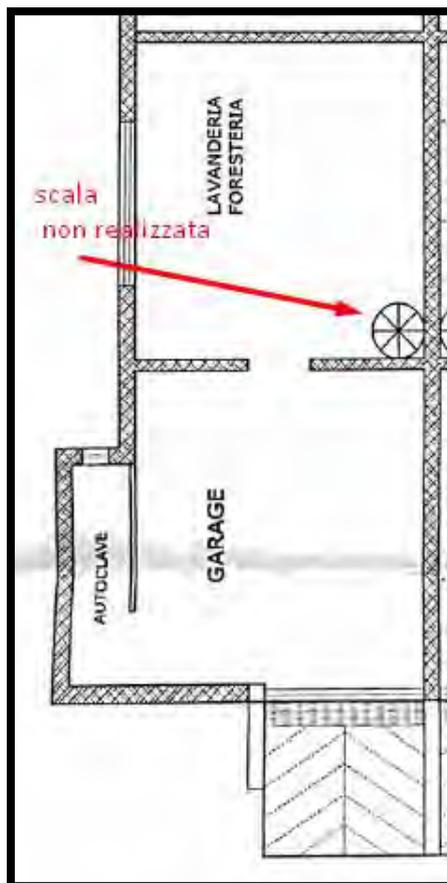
Pianta piano terra allegata alla CILA prat. n. 294/2011
